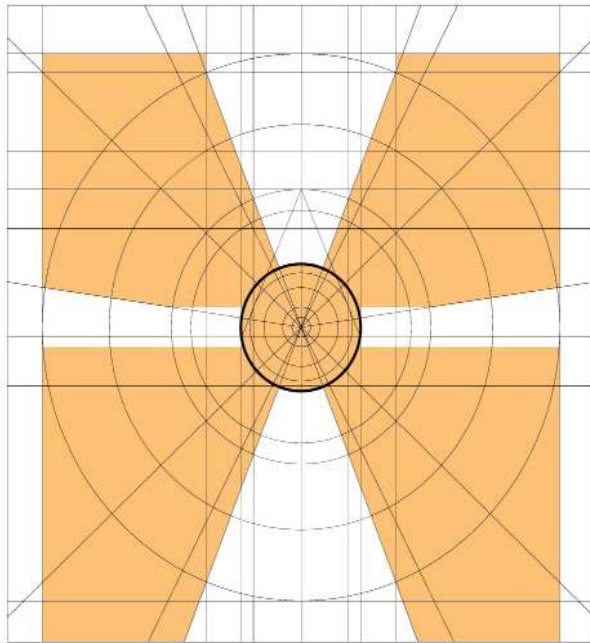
Forma de la Planta Baja - Retícula
